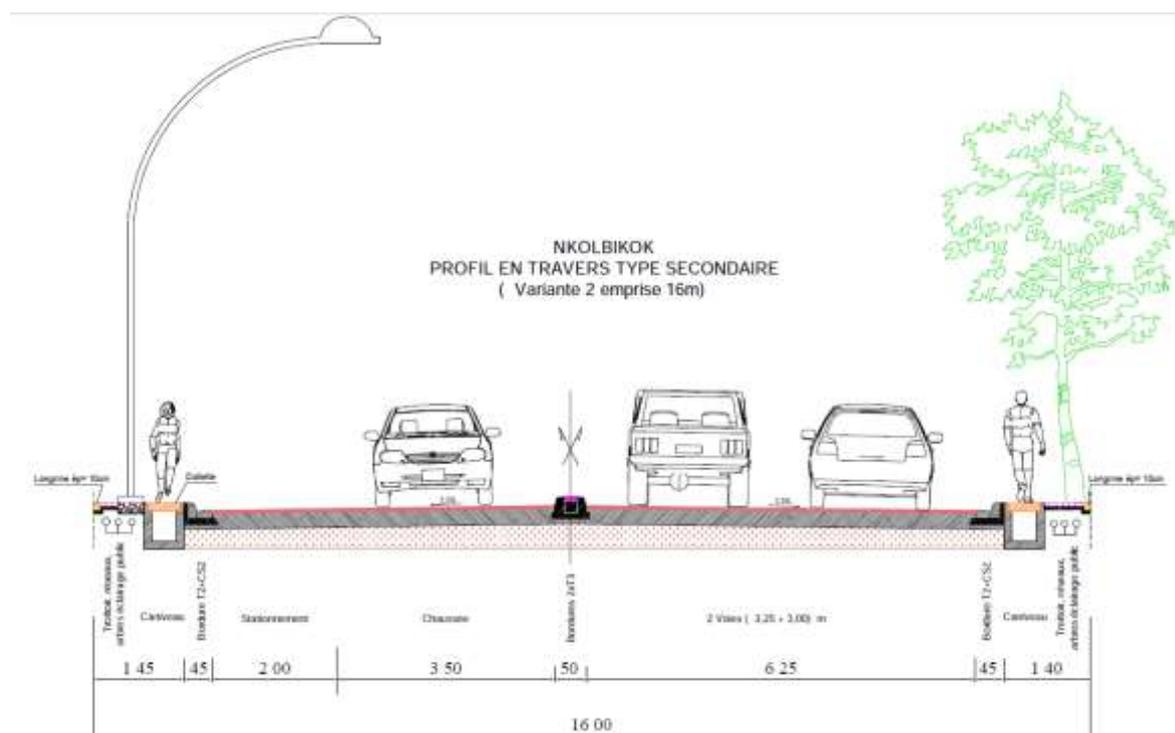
Profil en Travers Type de la Voie Secondaire Projetée (Variante 2)
